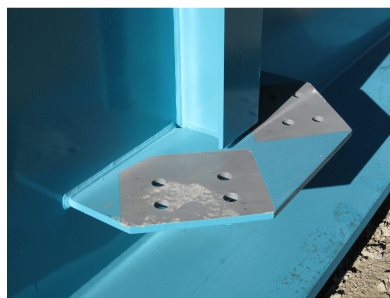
Fotografia de detalhe de placa soldada lateralmente à alma.
